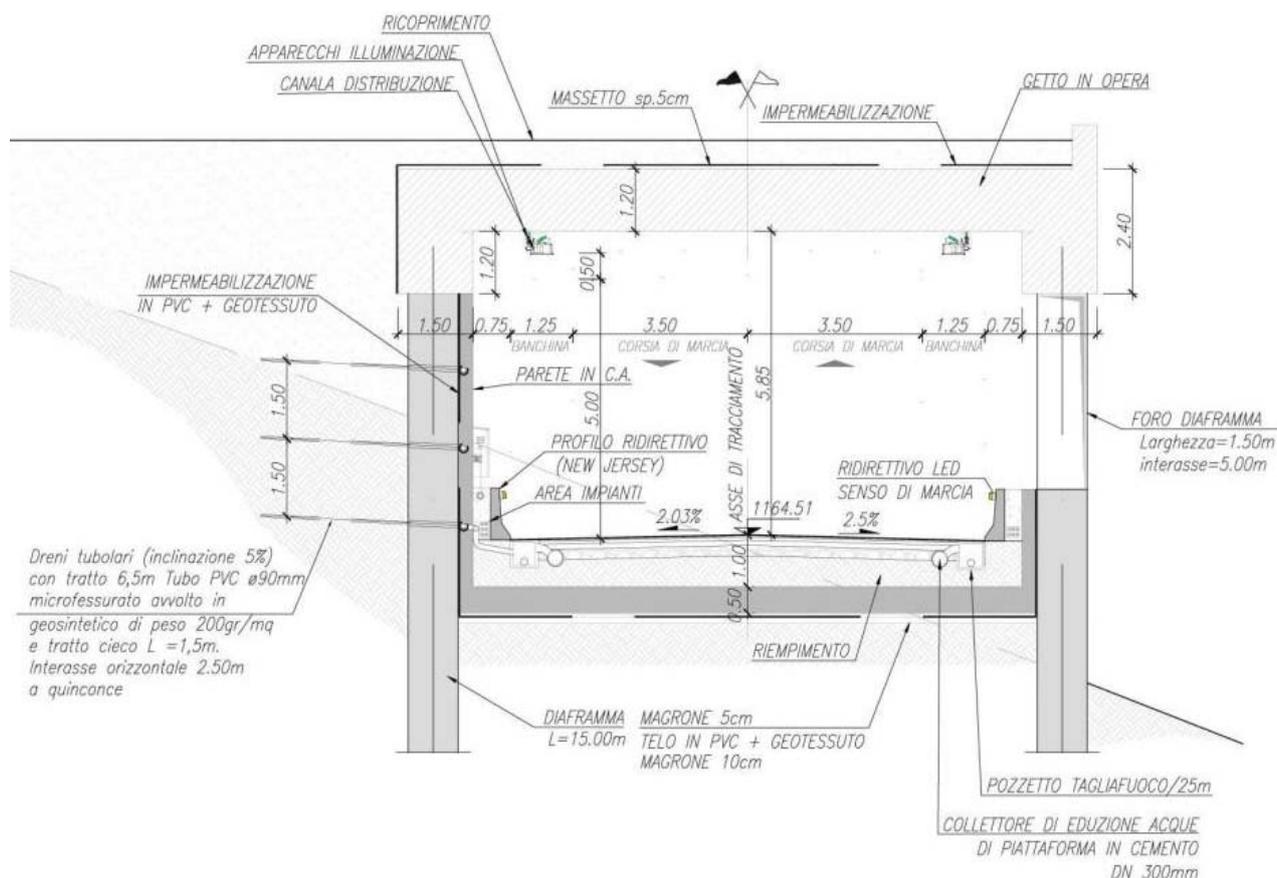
Tratto di galleria aperta (Sezione 08 - ns. elaborazione T01GA010STPF02_A_Planimetria, profilo e sezioni tav. 2/2 del progetto definitivo).
